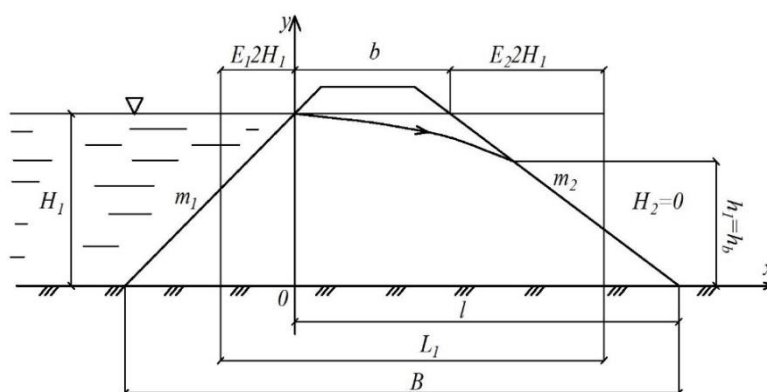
Расчётная схем фильтрации в анизотропной грунтовой плотине без дренажа.
